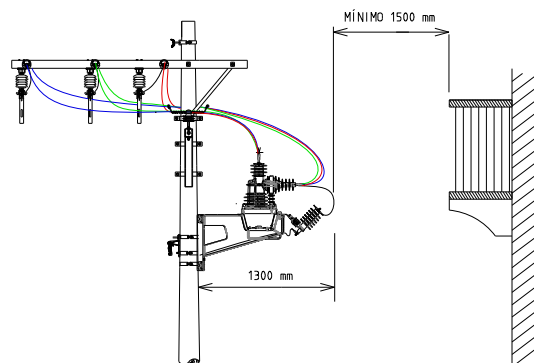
Afastamento horizontal entre ponto energizado e sacada ou janela de edificação.
